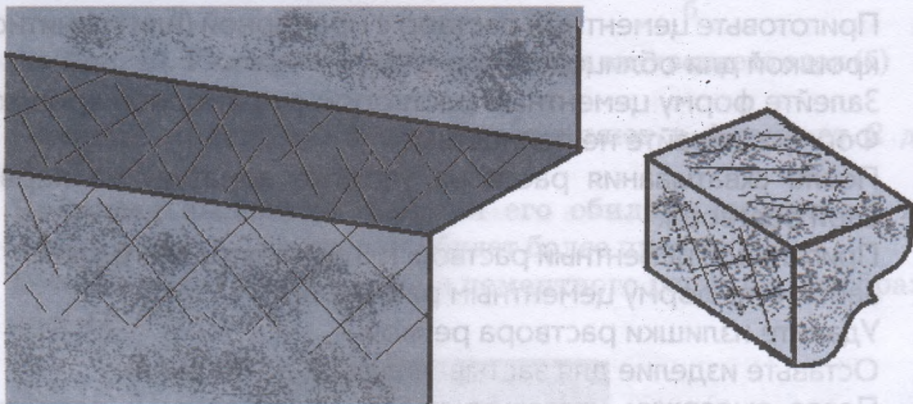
Насечка места крепления и тыльной стороны устанавливаемой детали
